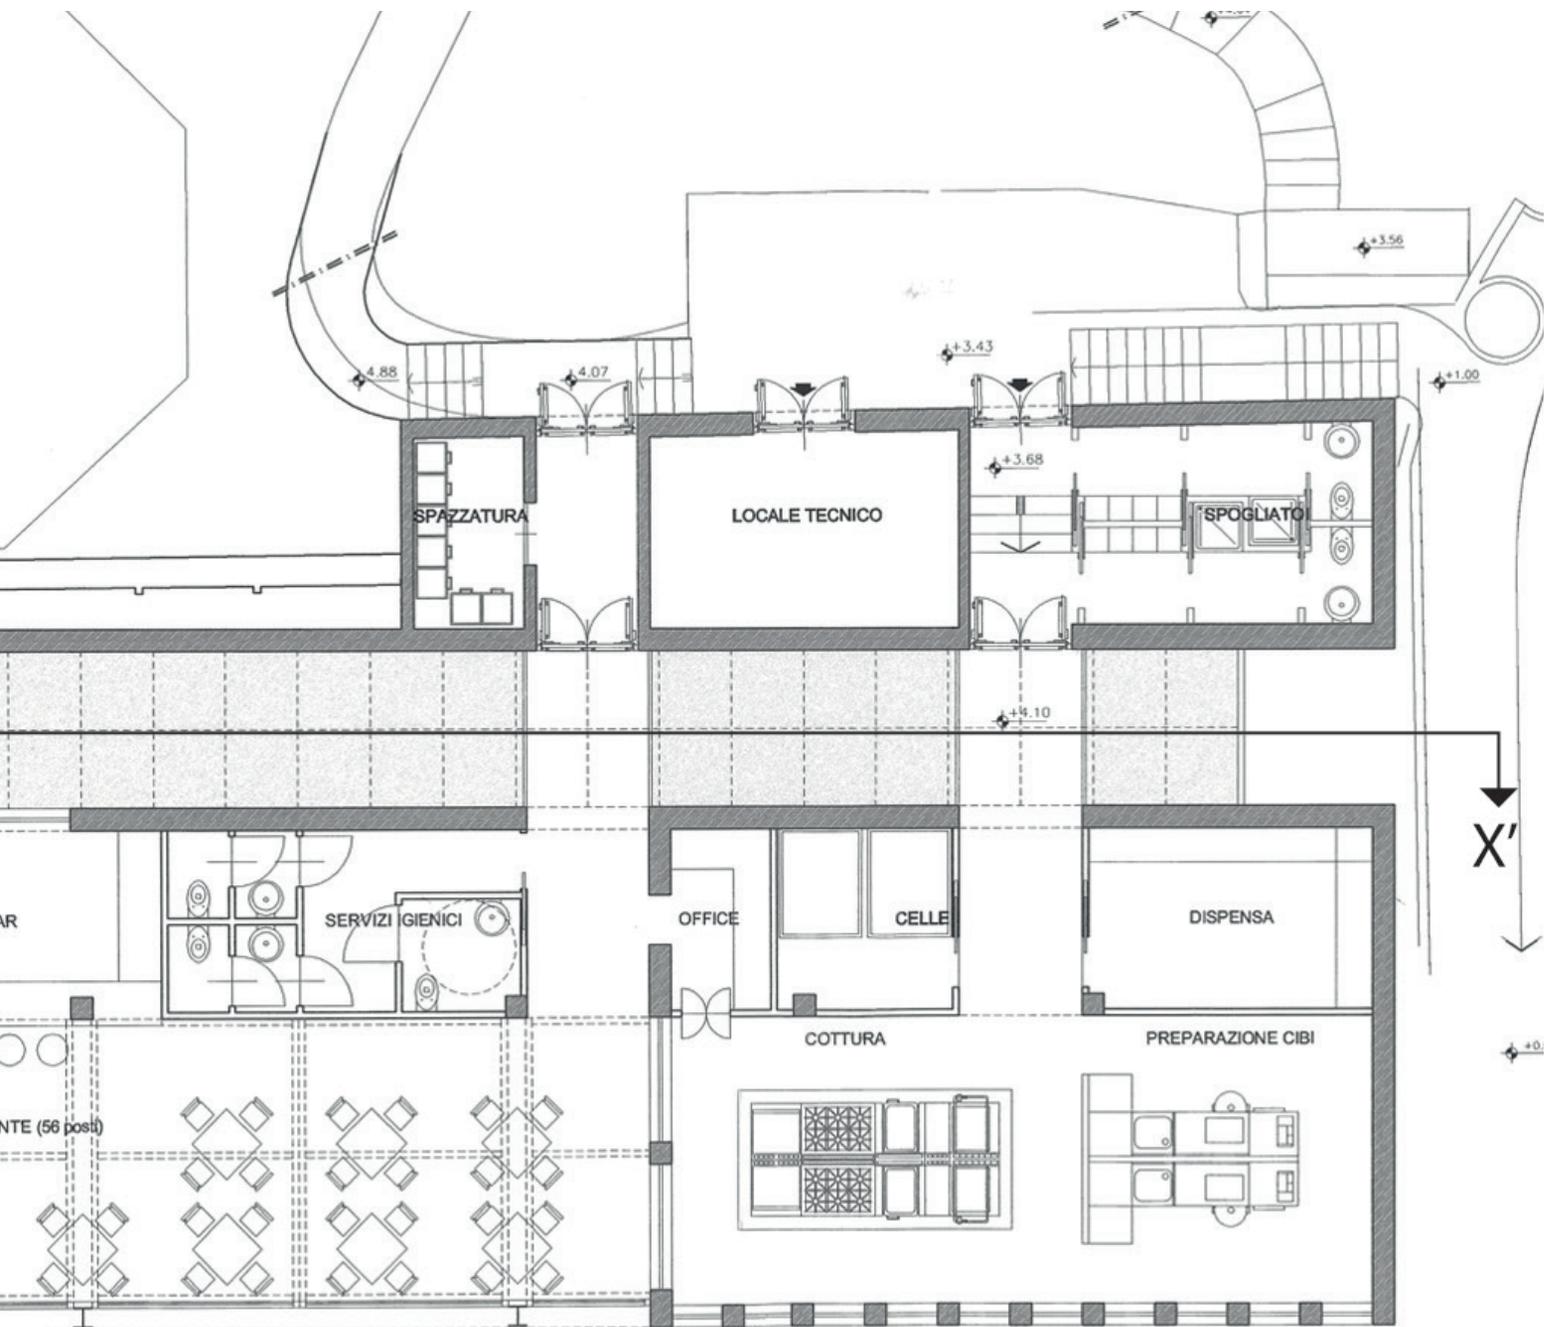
Progetto Gae Aulenti, disegni di archivio: la planimetria del piano sopraelevato (+4.10m) ospitante la terrazza ristorante, il ristorante e il bar (Archivio Progetti Comune di Genova - APCG).
